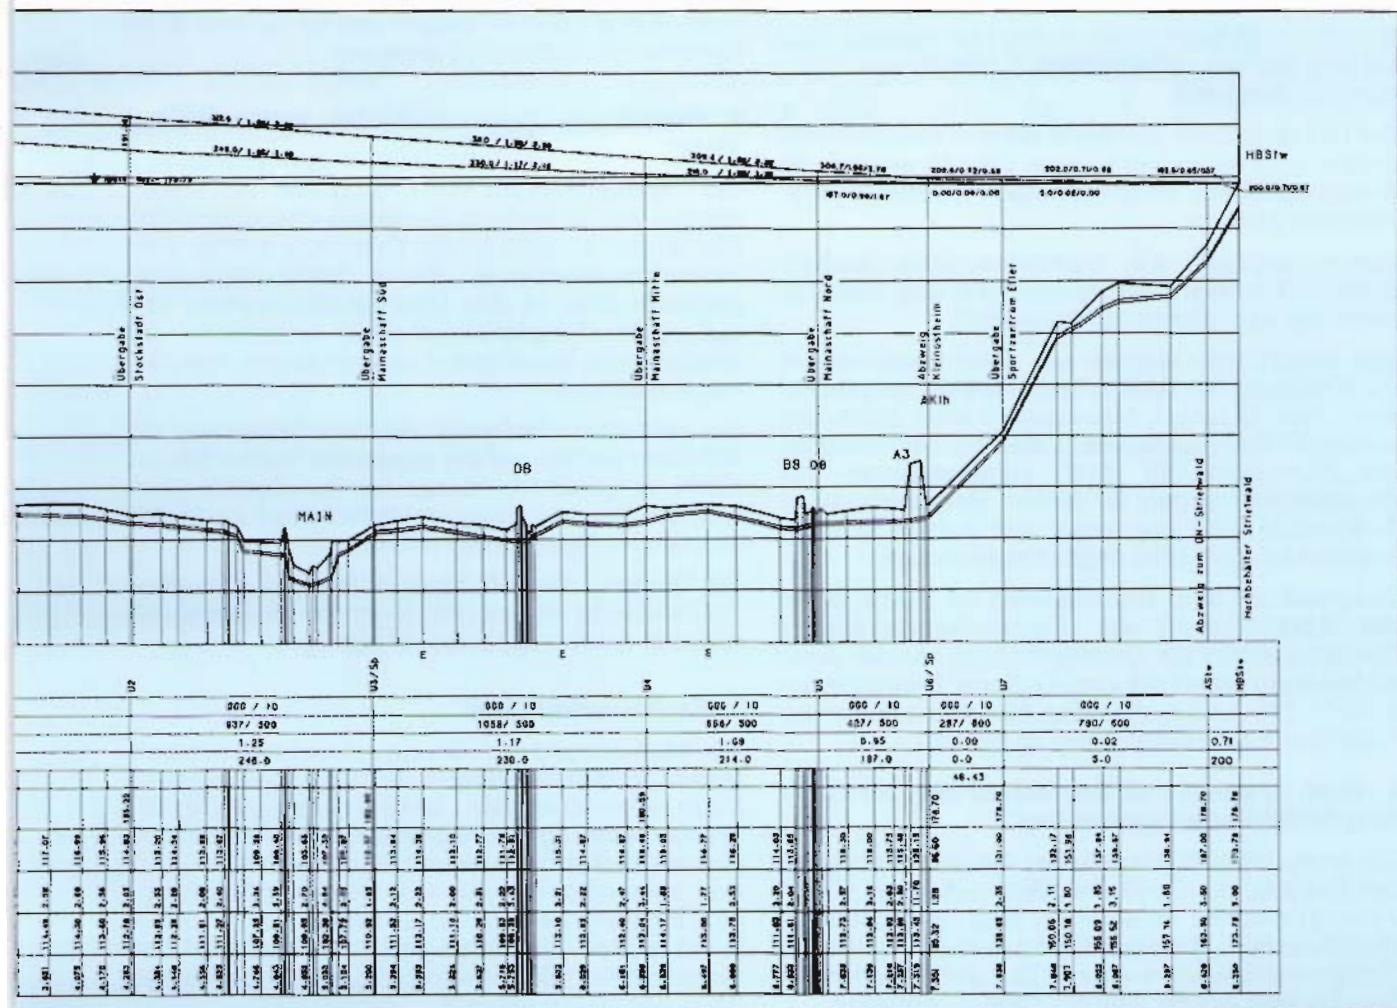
Bauabschnitt 04, Schieberkreuz Strietwald zum Hochbehälter
